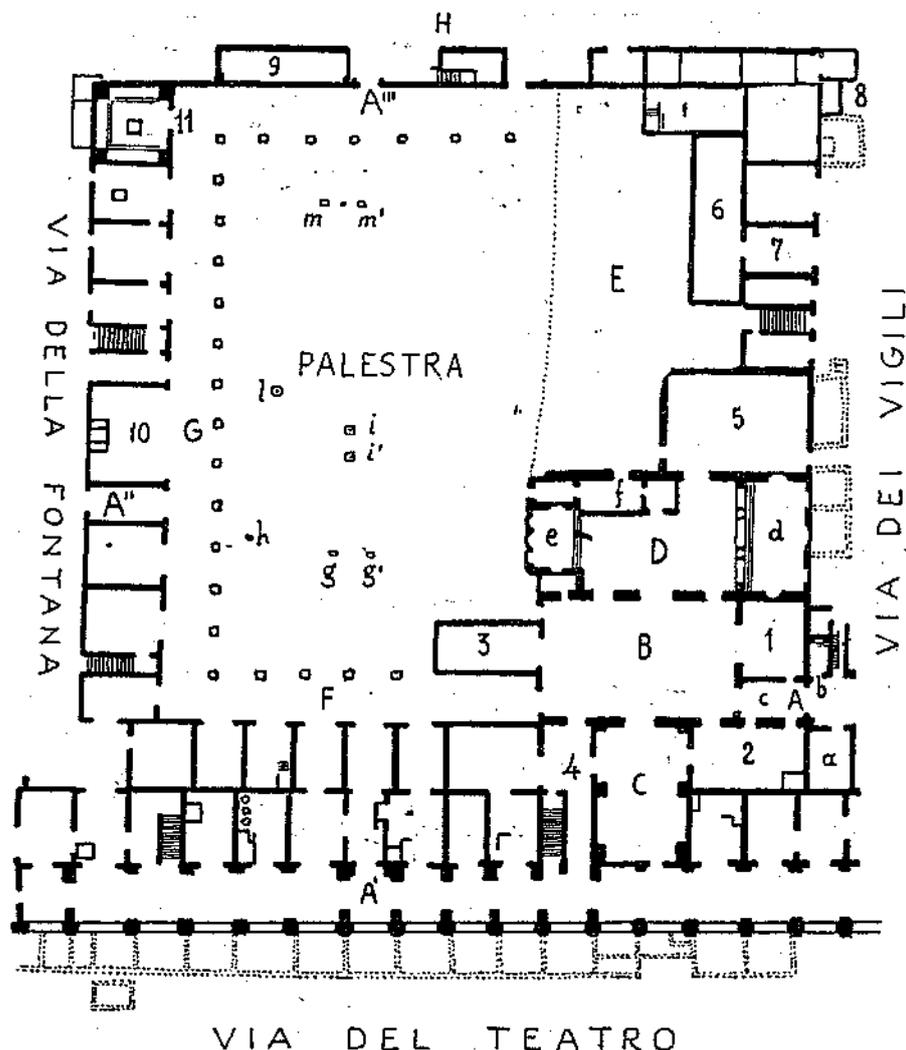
bis. - Pianta delle Terme (Scavi 1888, 1909-1911).
